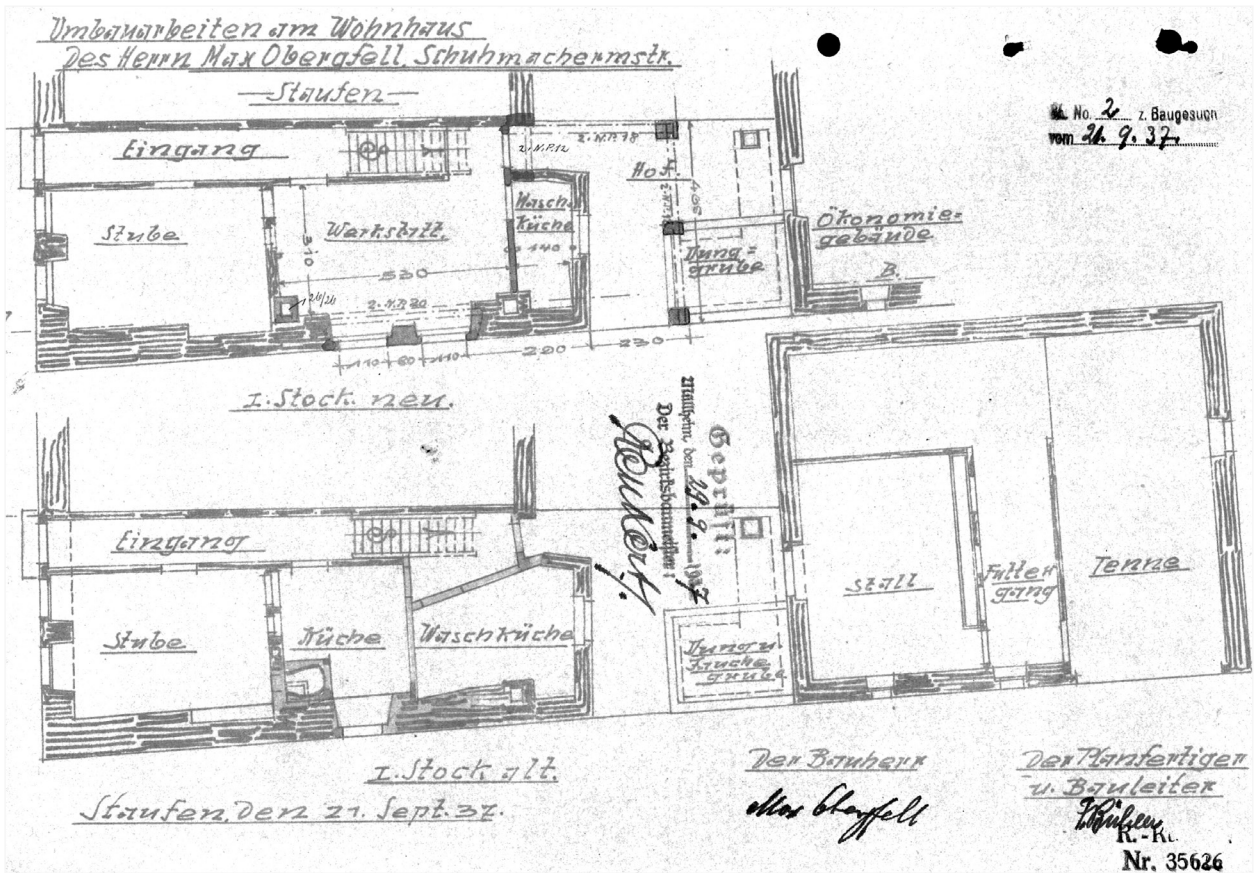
Hauptstraße 31, Grundriss Erdgeschoss, Zustand und Neuplanung von 1937.
